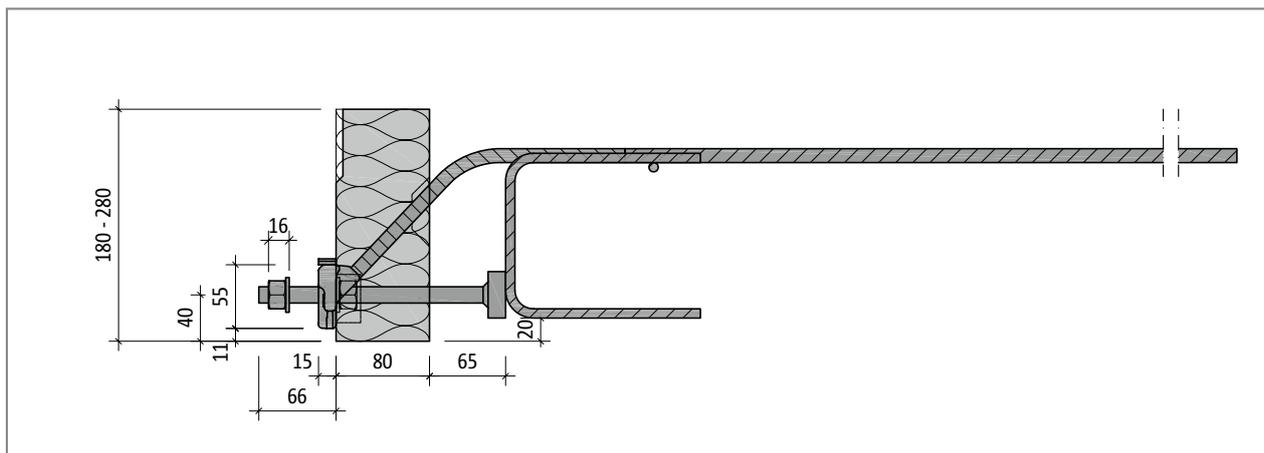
Schöck Isokorb® T type SQ-V3 : coupe du produit
